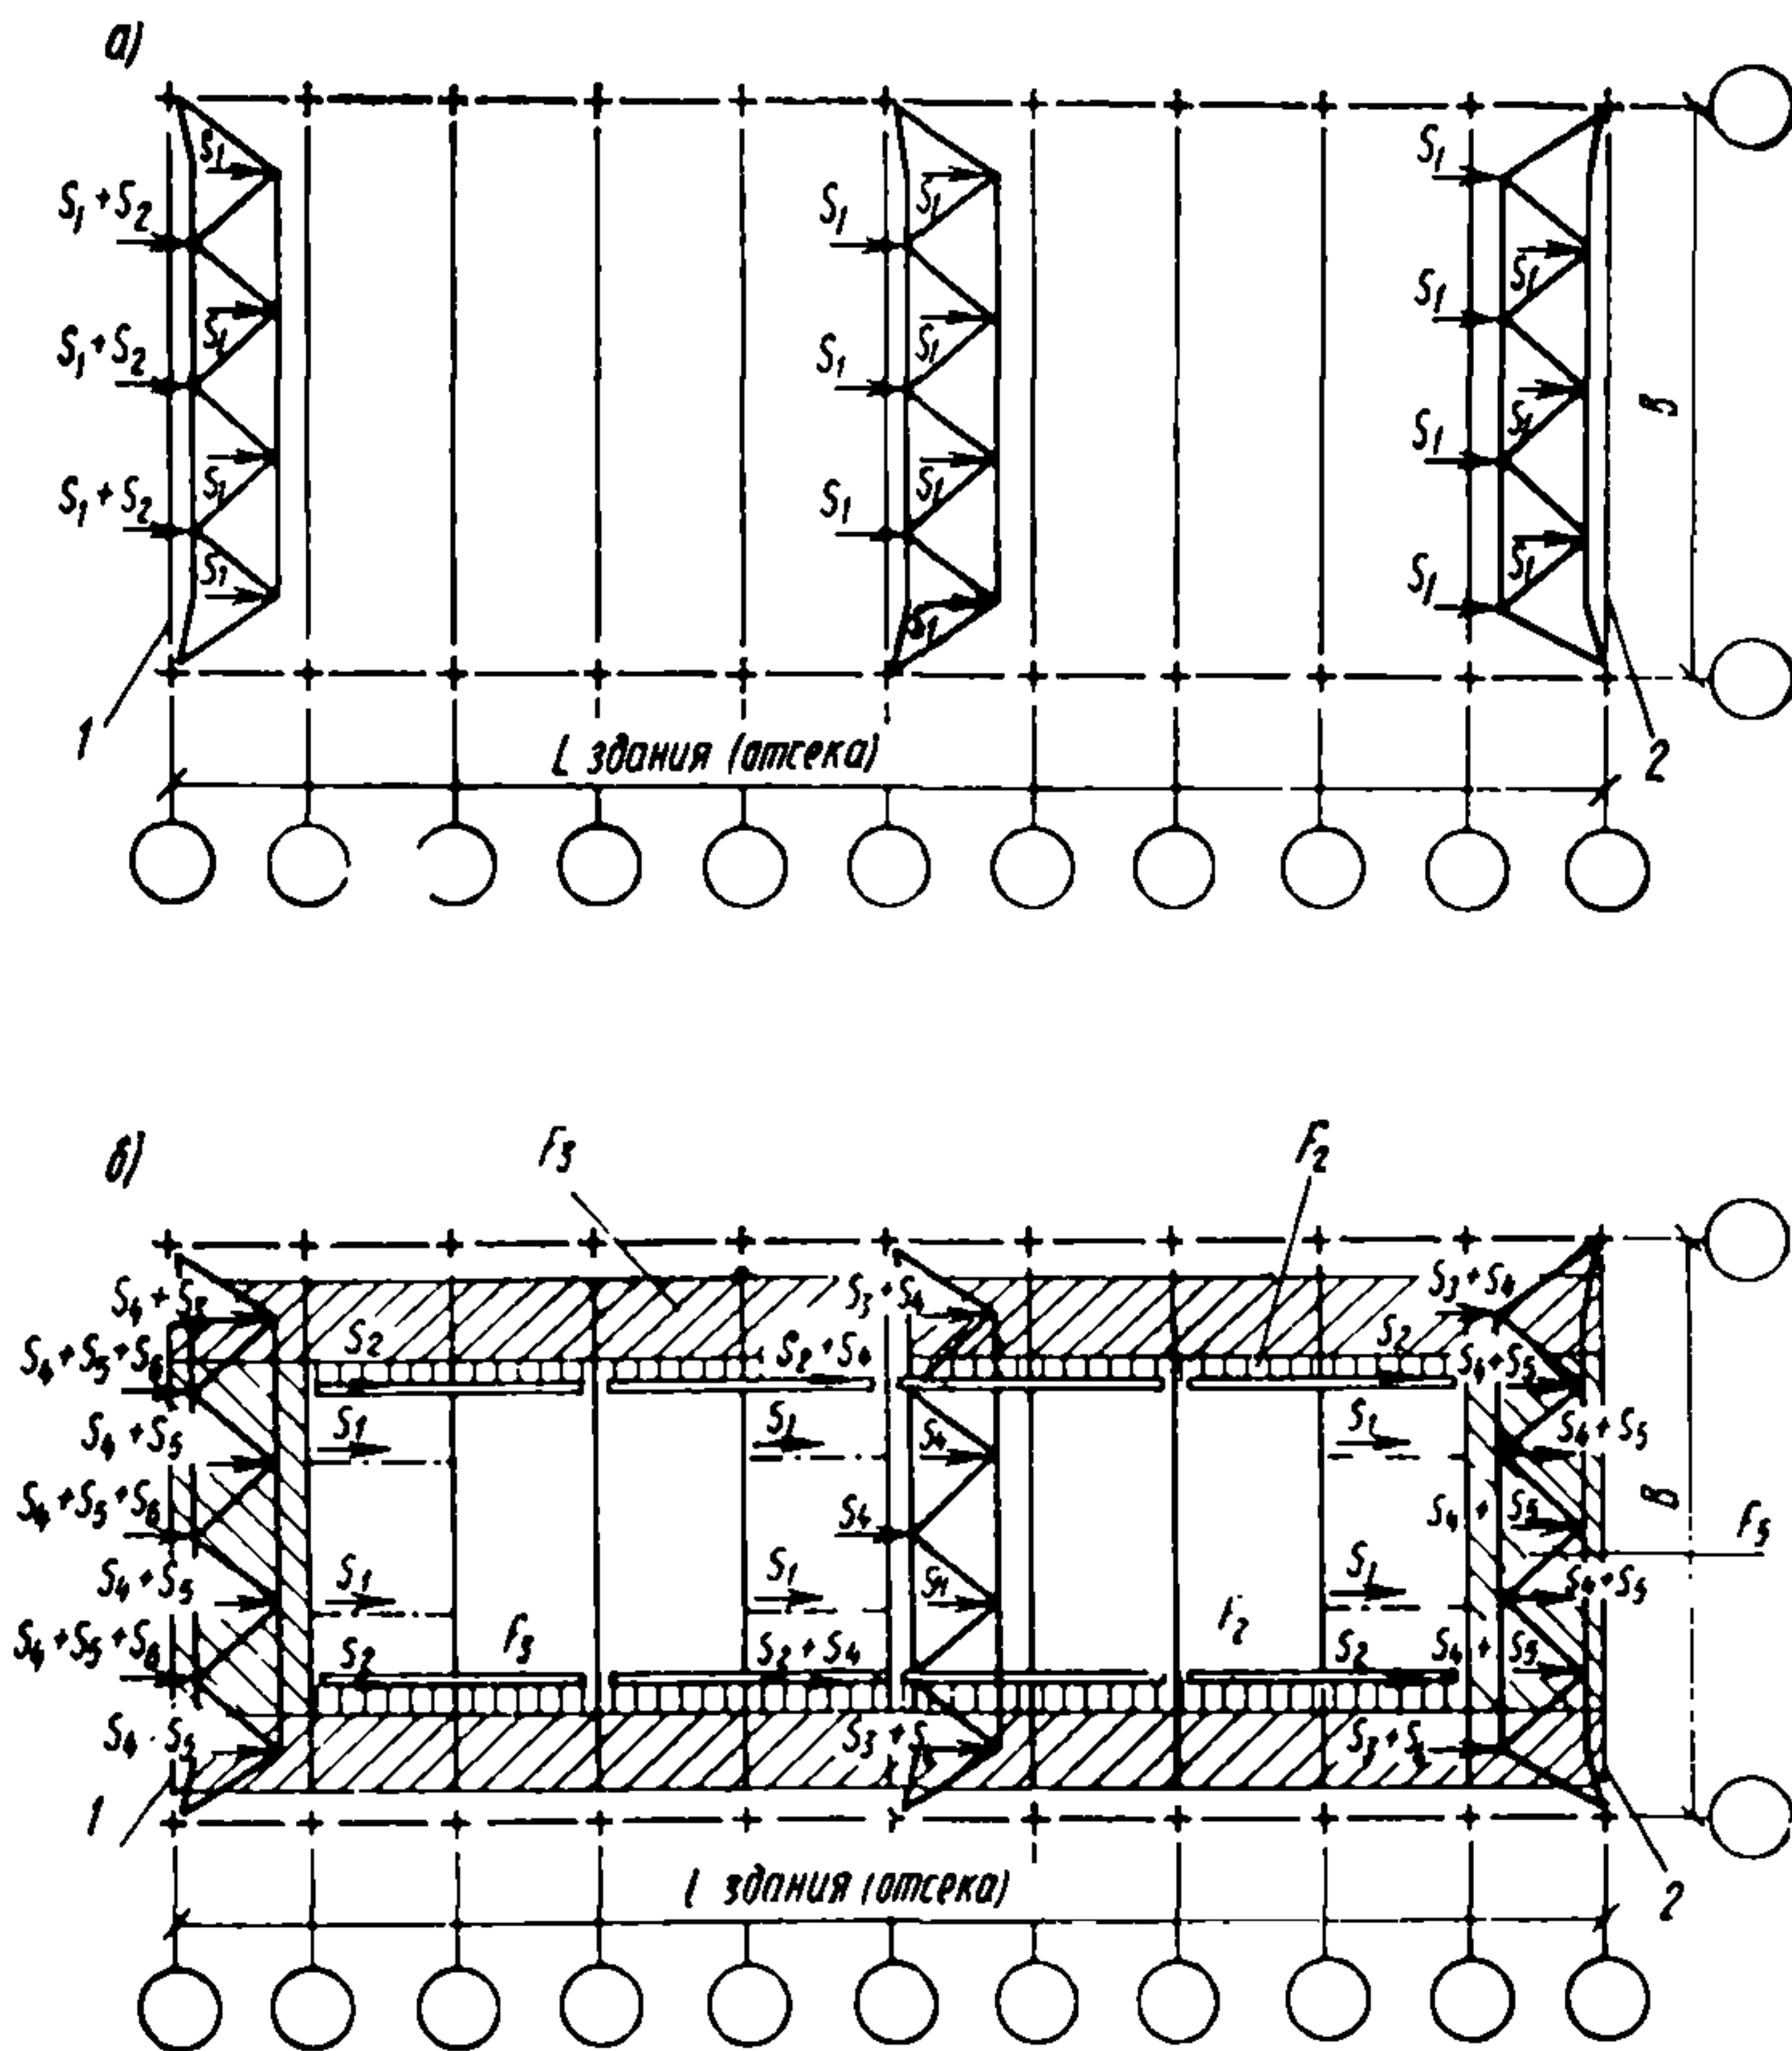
Схемы распределения продольных сейсмических нагрузок между узлами поперечных связевых ферм в плоскости верхних поясов стропильных ферм бесфонарного пролета покрытия (а) и пролета с фонарем (б)
